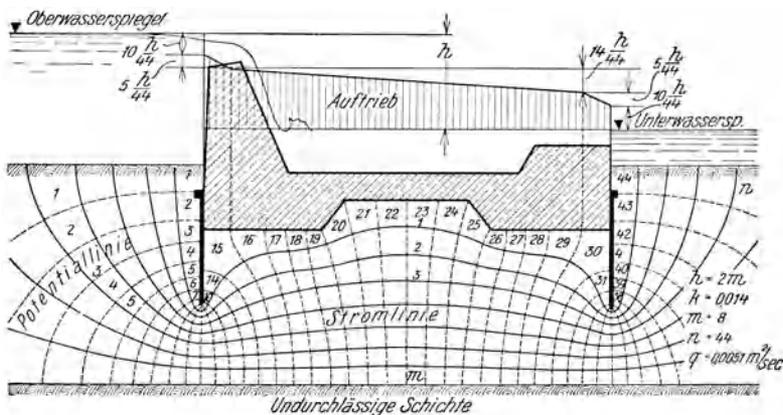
Zeichnerische Ermittlung der Sickerung unter einem Stauwehr. (Aus SCHOCKLITSCH: Der Wasserbau I, S. 183.)
